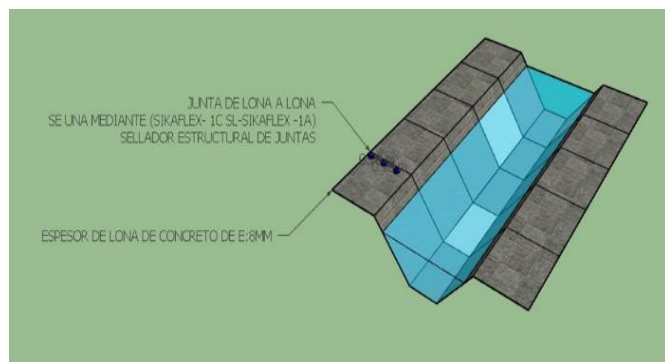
Sección transversal del canal con lona de concreto en vista 3D. Elaboración propia
